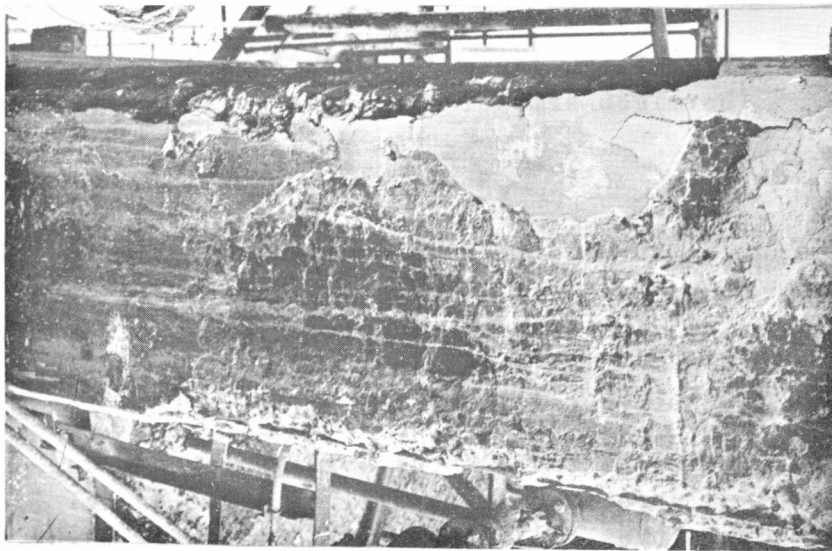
Estructura de hormigón armado afectada por el fuego
